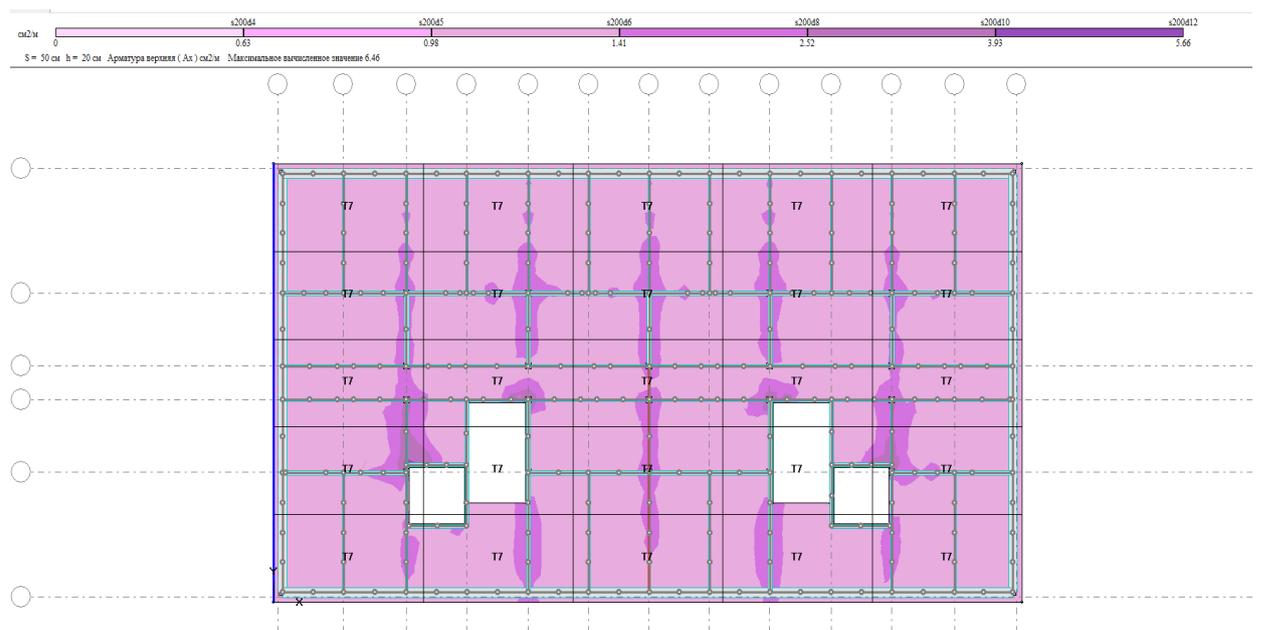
Изополя верхнего армирования плиты перекрытия по Оси X
